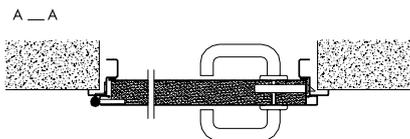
Horizontalschnitt Stahlaußentüren ECO mit Eckzarge.
